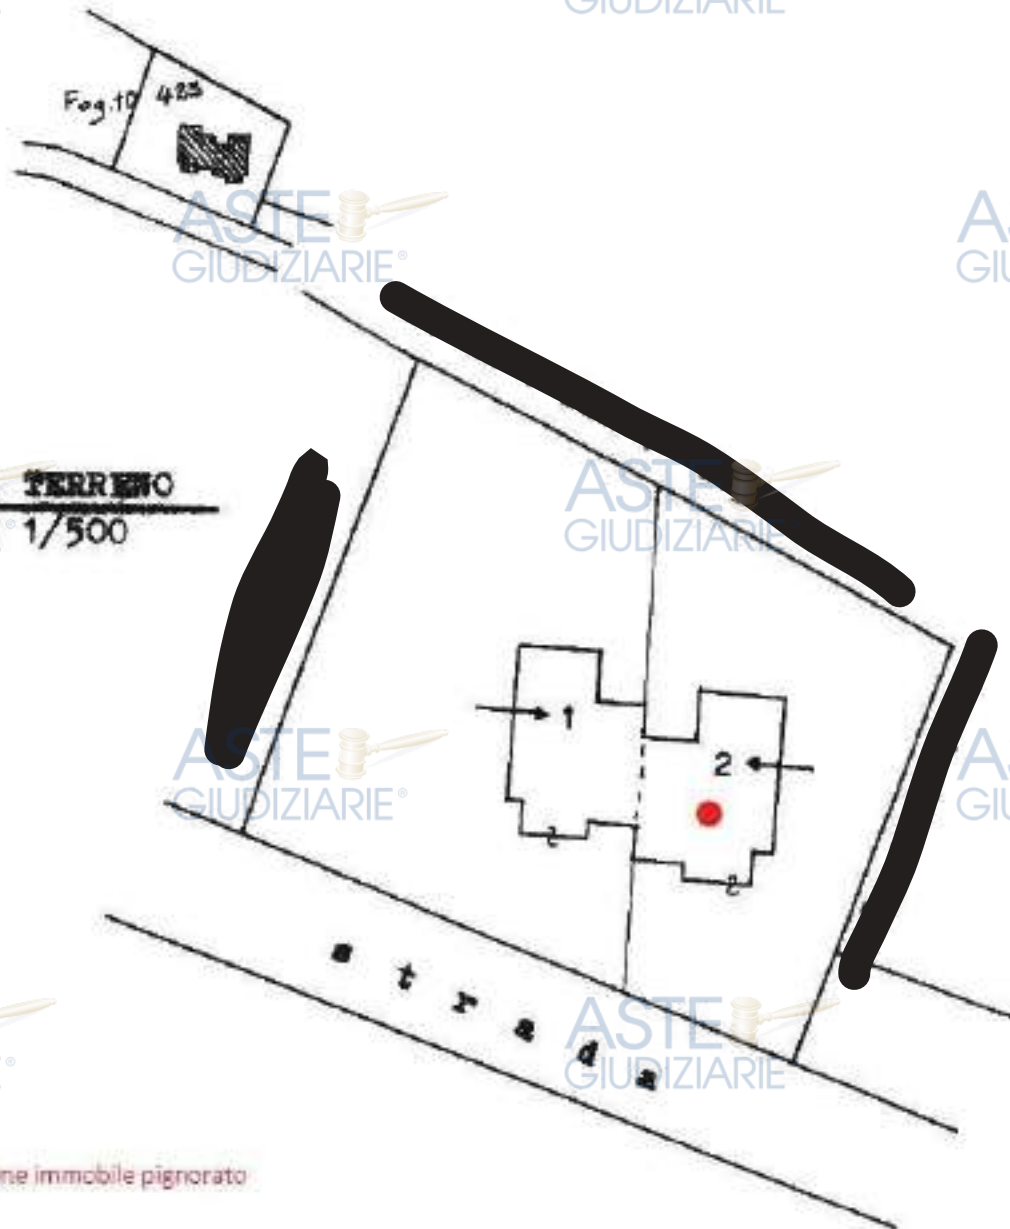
Ubicazione planimetrica dei beni immobili pignorati GRUPPO H89
